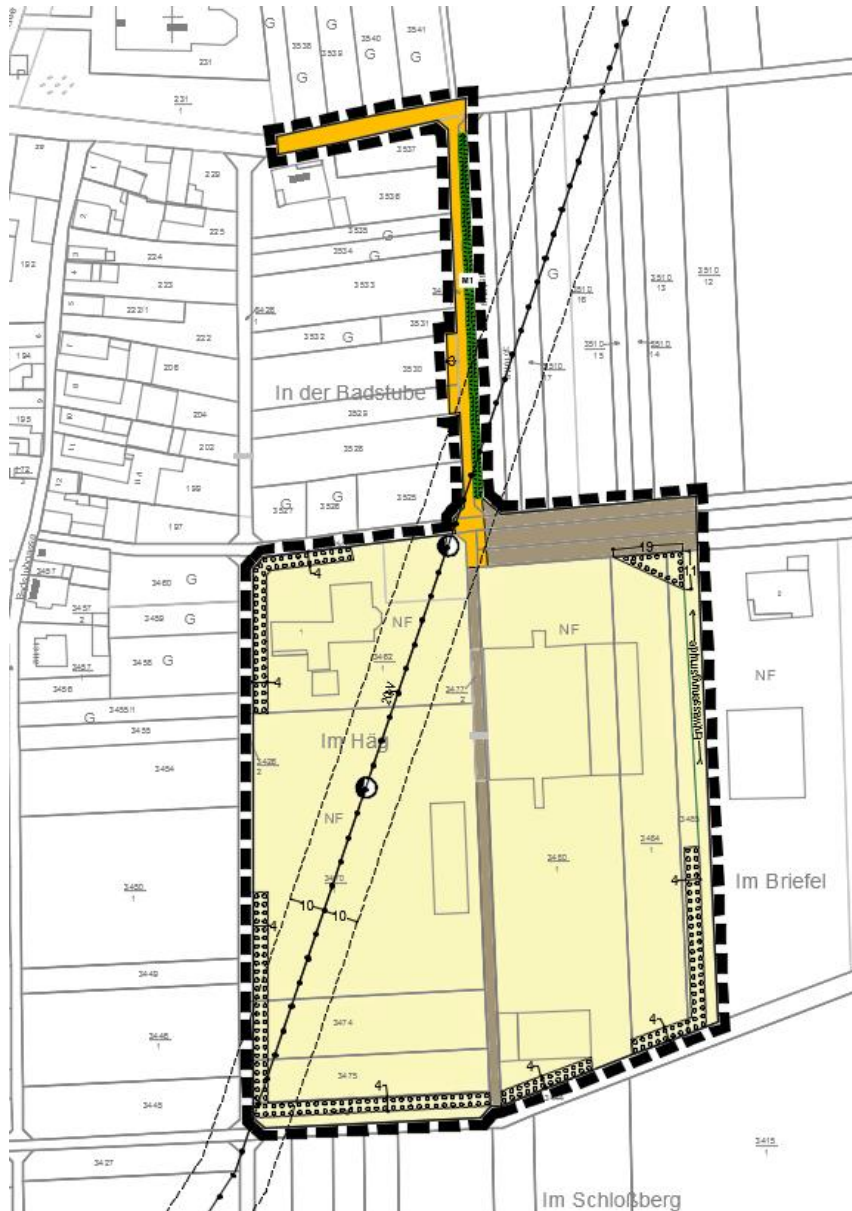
Bebauungsplan - Planzeichnung, Quelle: eigene Darstellung
